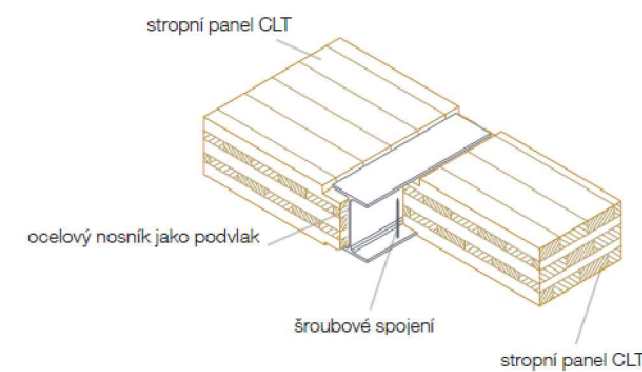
DETAIL ULOŽENÍ KLH PANELU NA HEA PROFIL
